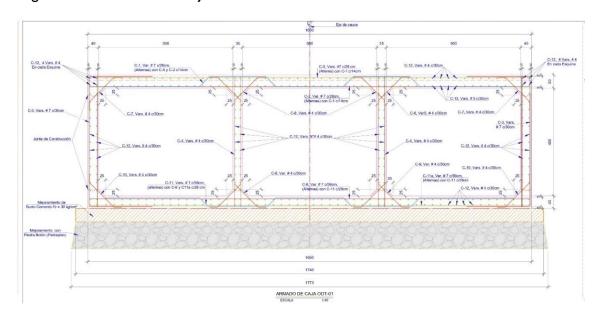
Vista de las cajas 3 CCR 4 X 4 m
